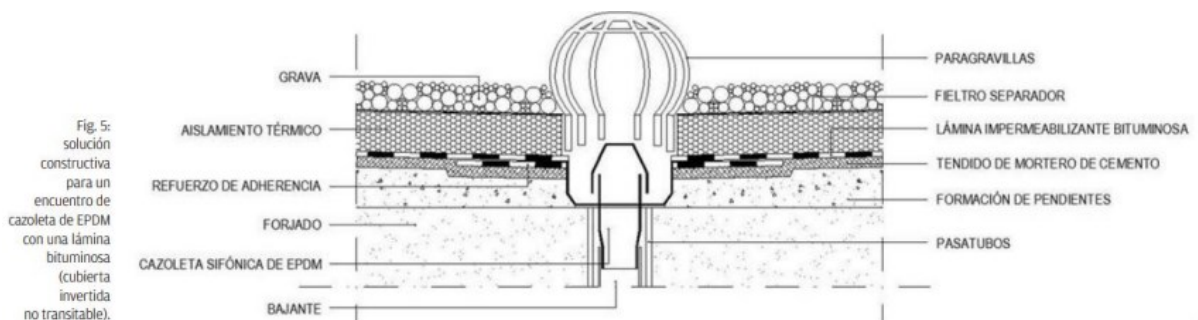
Detalle sumidero pluvial en cubierta no transitada (Ayuso, 2016)
